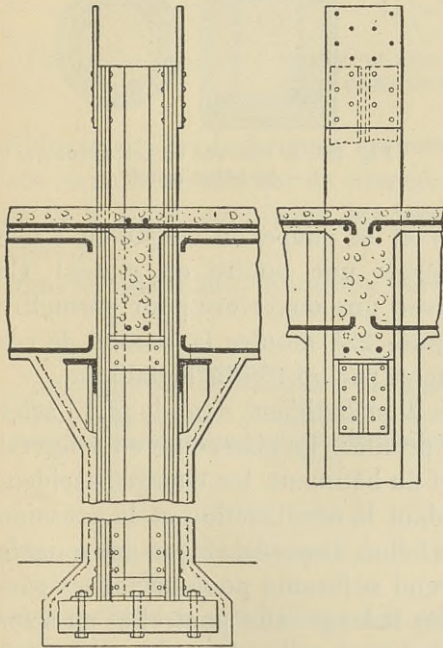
Poteau composé en acier et plancher en béton armé.
